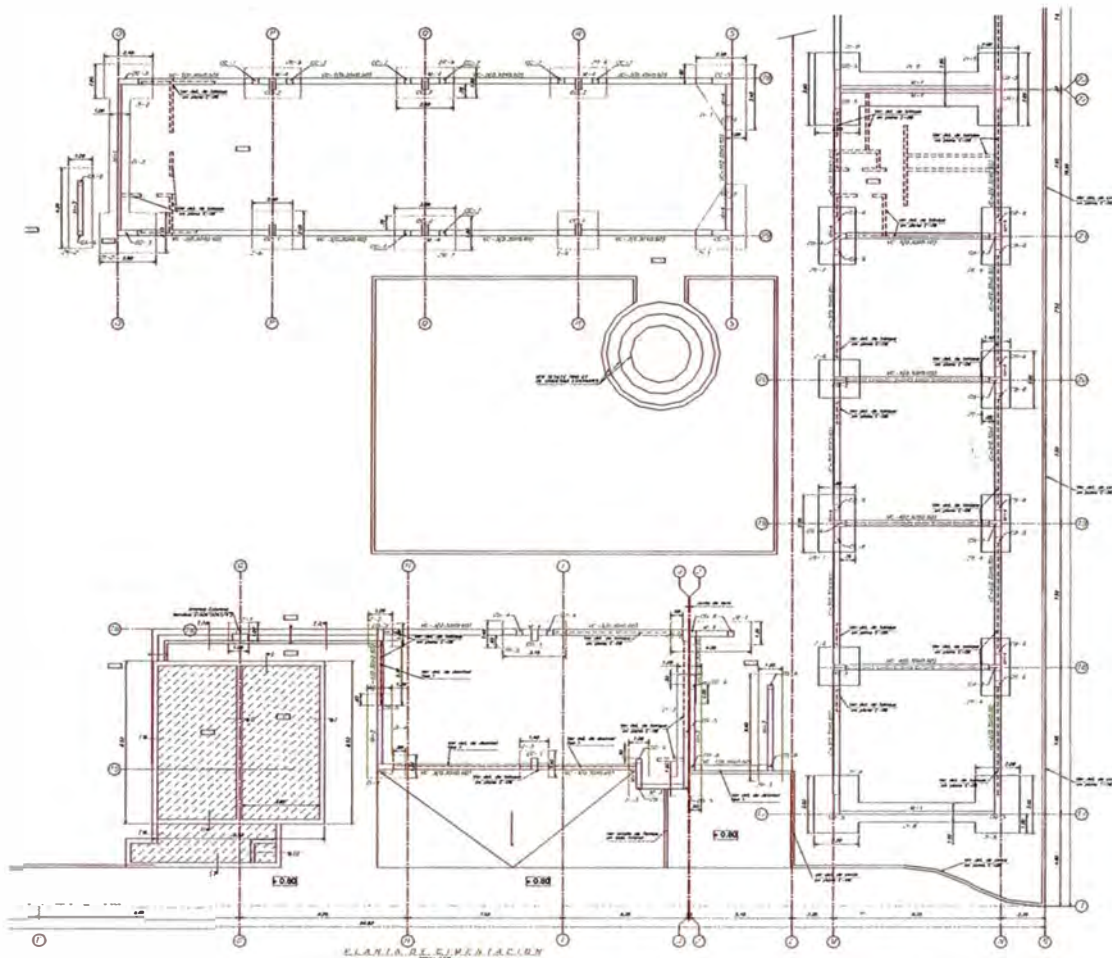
Subestructura: Cisterna y Cimentaciones.
